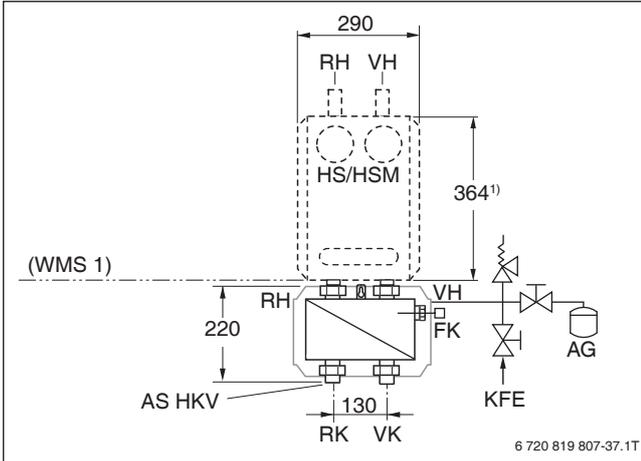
Abmessungen Anschluss-Set Wärmetauscher Systemtrennung mit Heizkreisanschluss-Set (Maße in mm)
